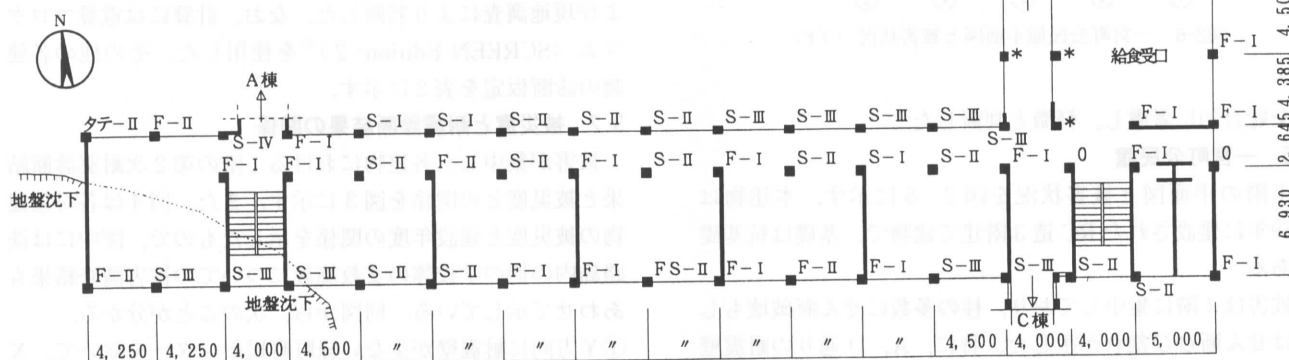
東浦中学校B棟の平面図と被害状況（1F）
